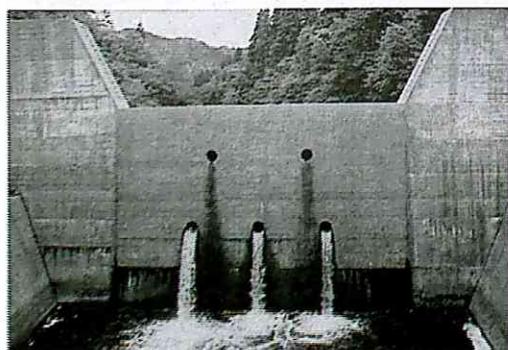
コンクリート製スリットダムの施工例（御備川第3号砂防堰堤）
